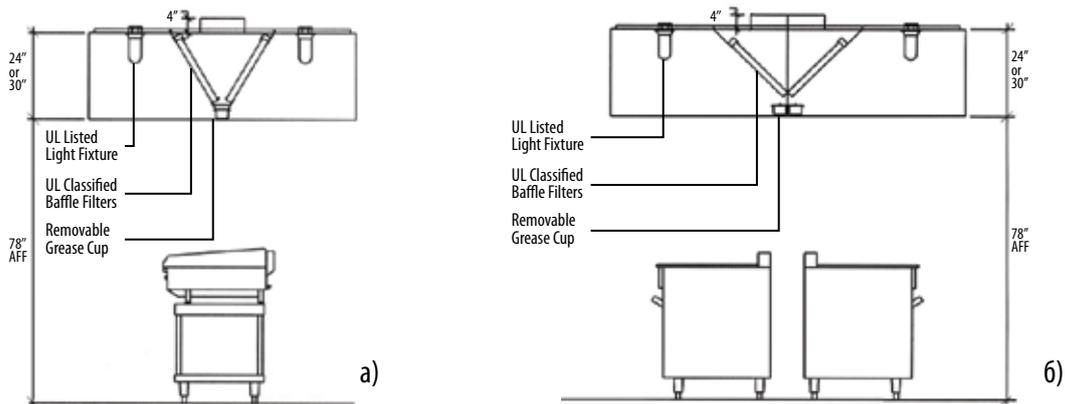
Схемы зонта над одинарным (а) и сдвоенным (б) оборудованием, расположенным на расстоянии от стен помещения. Вытяжной зонт над кухонным оборудованием, расположенный на расстоянии от стен помещения, требует большего расхода воздуха и, соответственно, энергии на его перемещение. Кроме того, значительное количество энергии используется для нагрева, охлаждения и транспортировки воздуха, предназначенного для компенсации удаляемого воздуха
